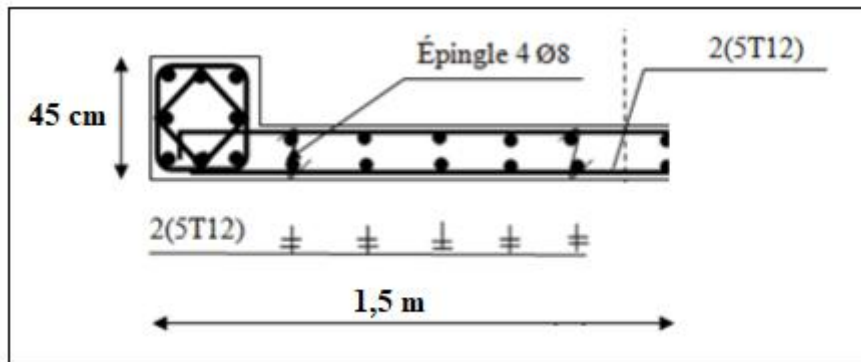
Schéma de ferrailage d'un trumeau.
